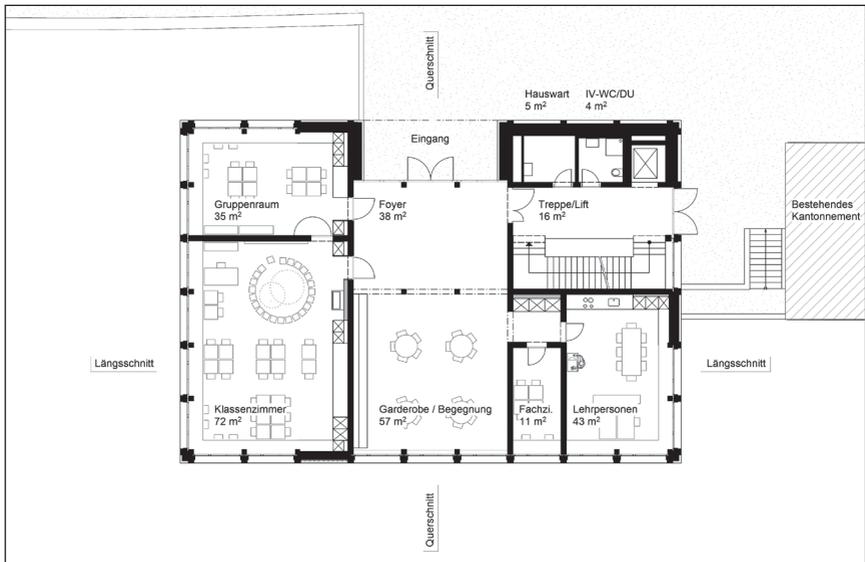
Grundriss Erdgeschoss, ohne Masstab, Stand: 24.04.2024
